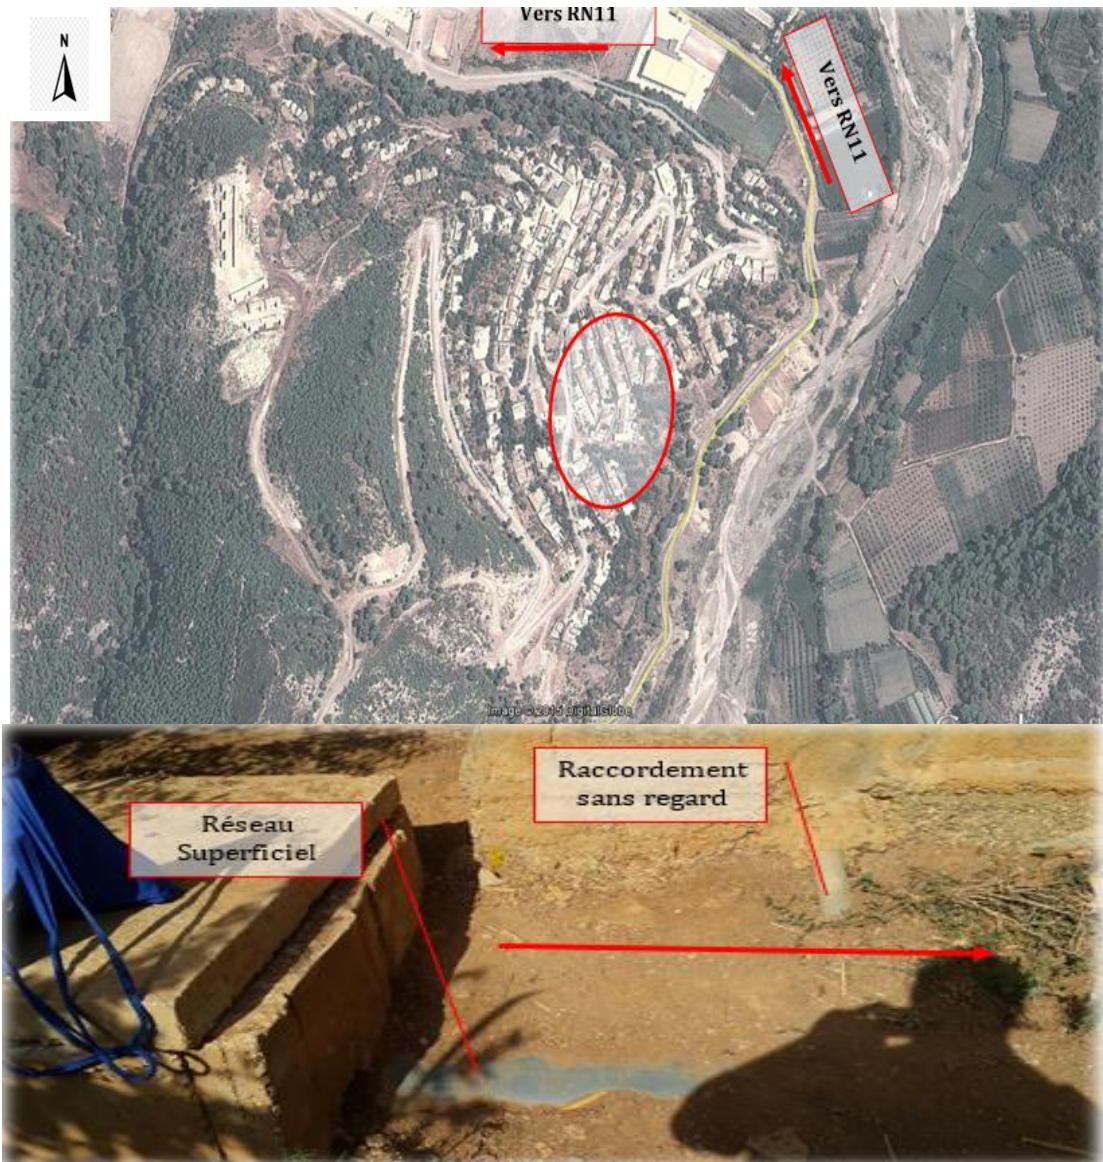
Le réseau d'assainissement Existant (Assainissement des banquettes).
